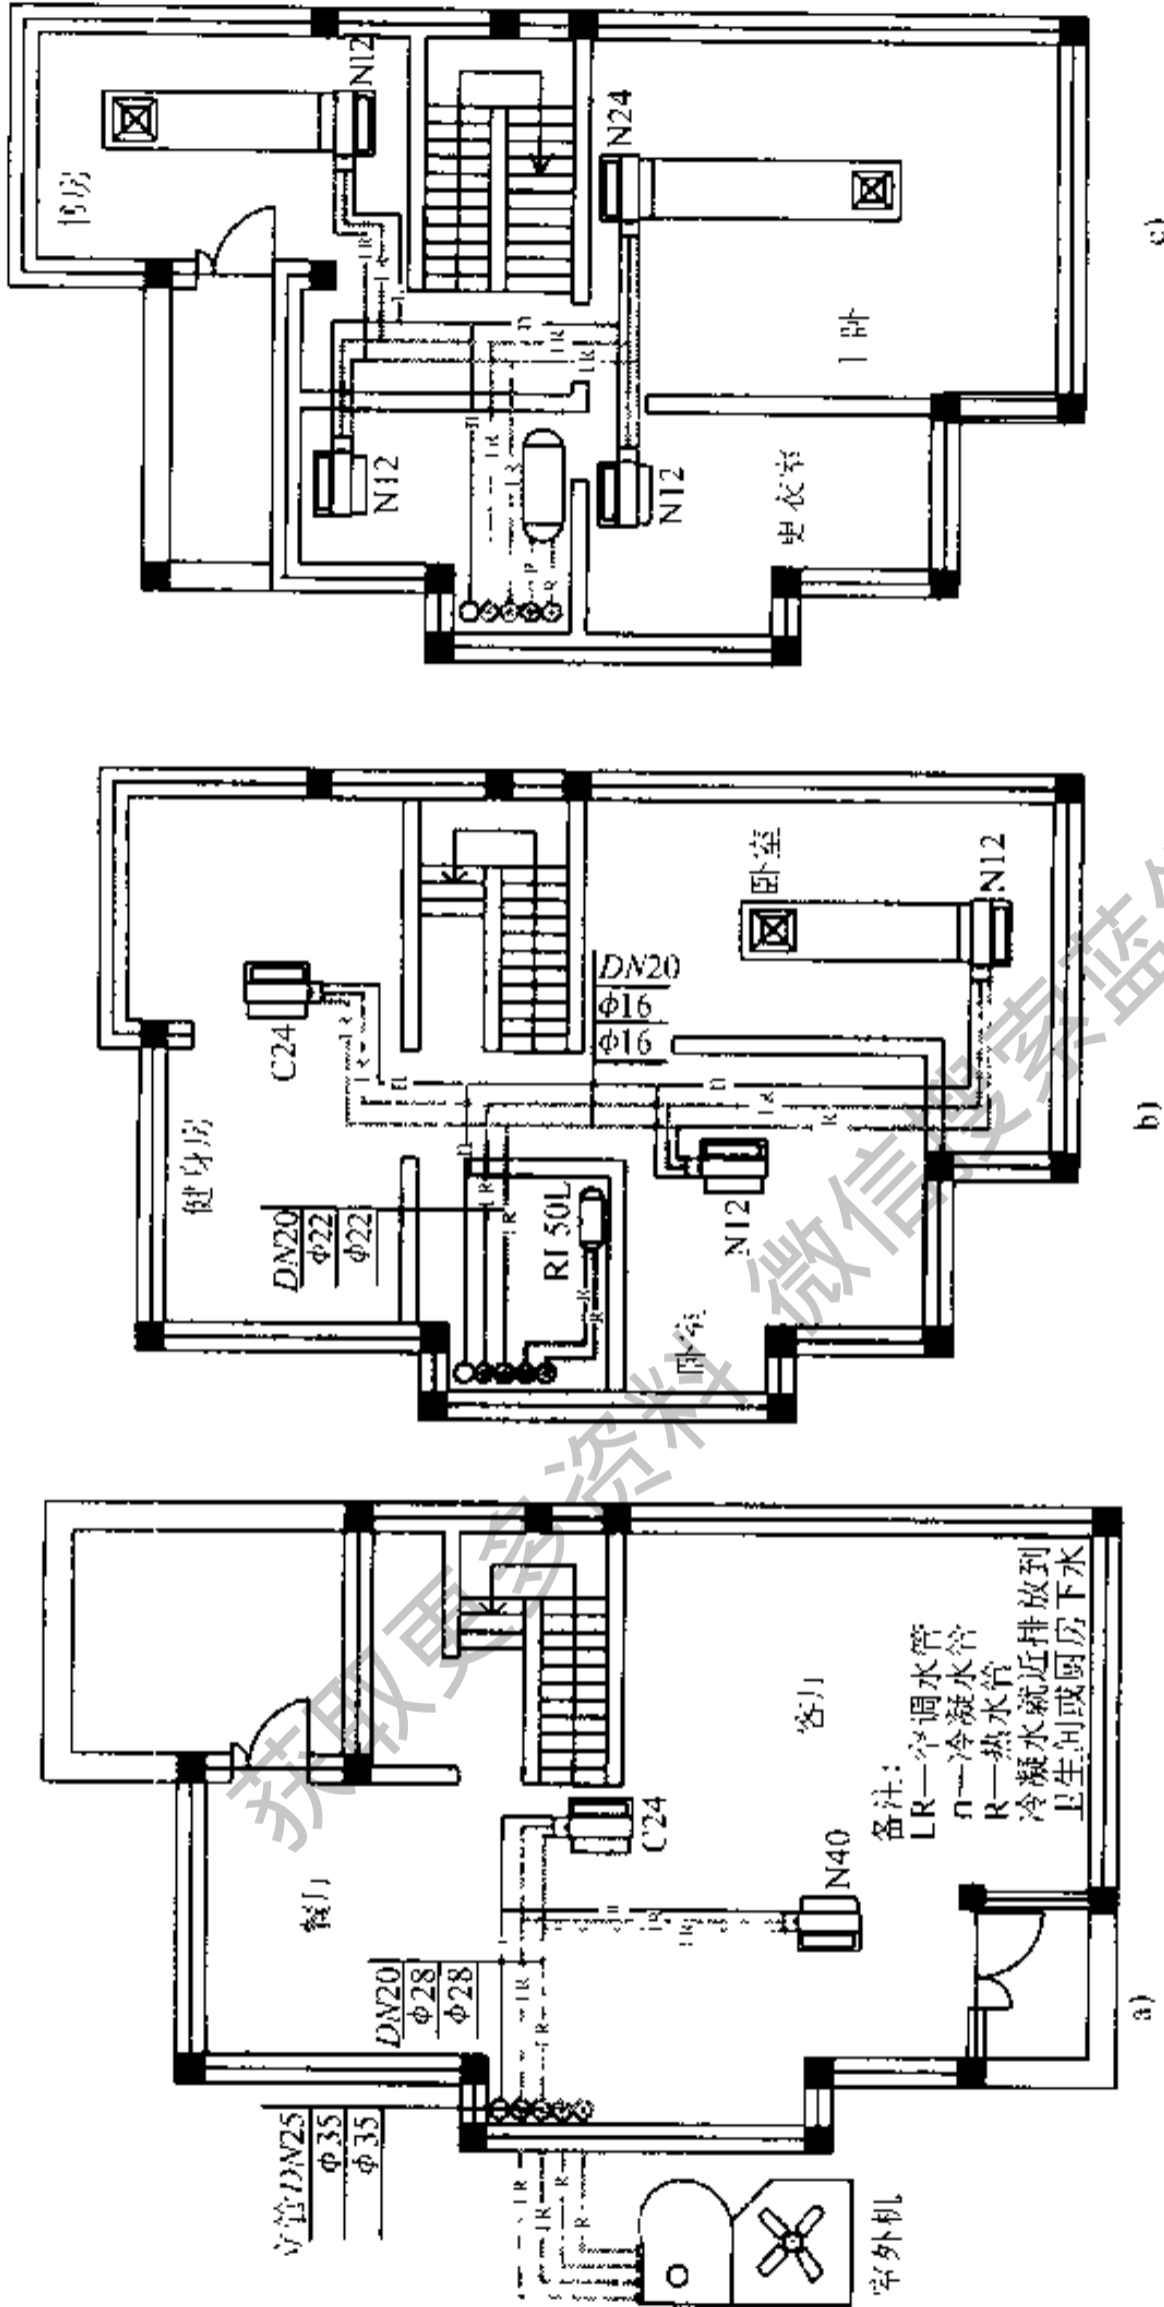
水蓝郡空调平面图 a) 层空调平面图 b) 二层空调平面图 c) 三层空调平面图
